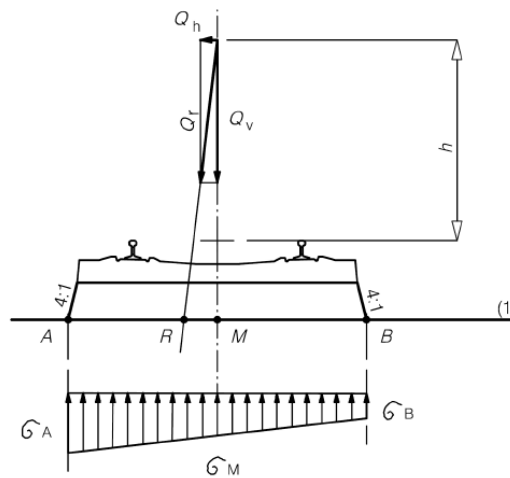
Distribuição transversal da carga pela travessa e pelo balastro num troço de via sem sobrelevação.
